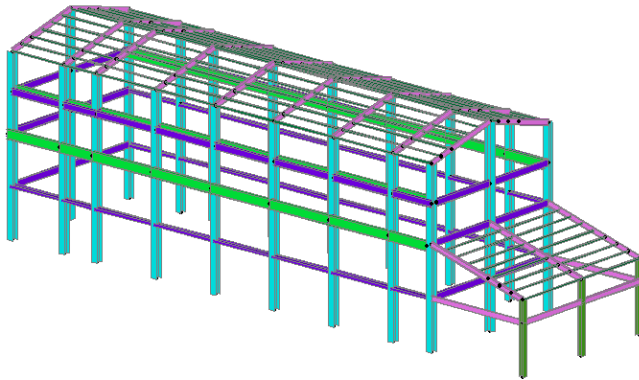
Denah kolom elv. +0.75 sampai +6.45
